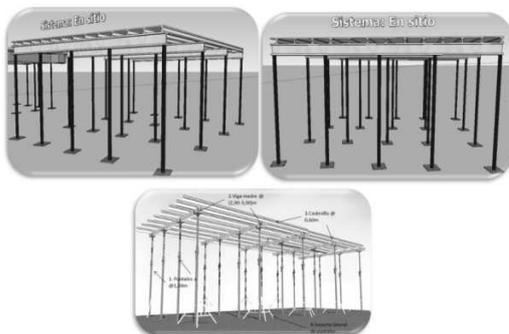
Recomendación de separación de puntales y vigas para formaleta. Del autor
